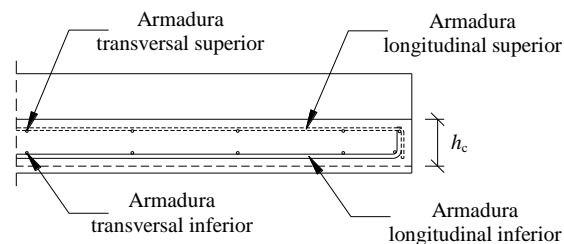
Secção longitudinal da laje de betão armado (secção AA).
